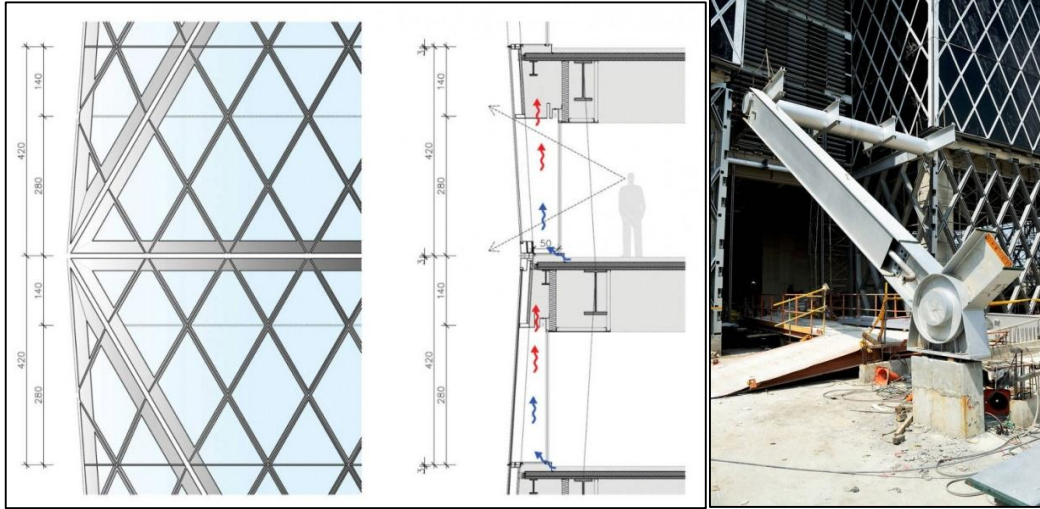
مسقط مقر شركة فولاذ الصين - تايوان
